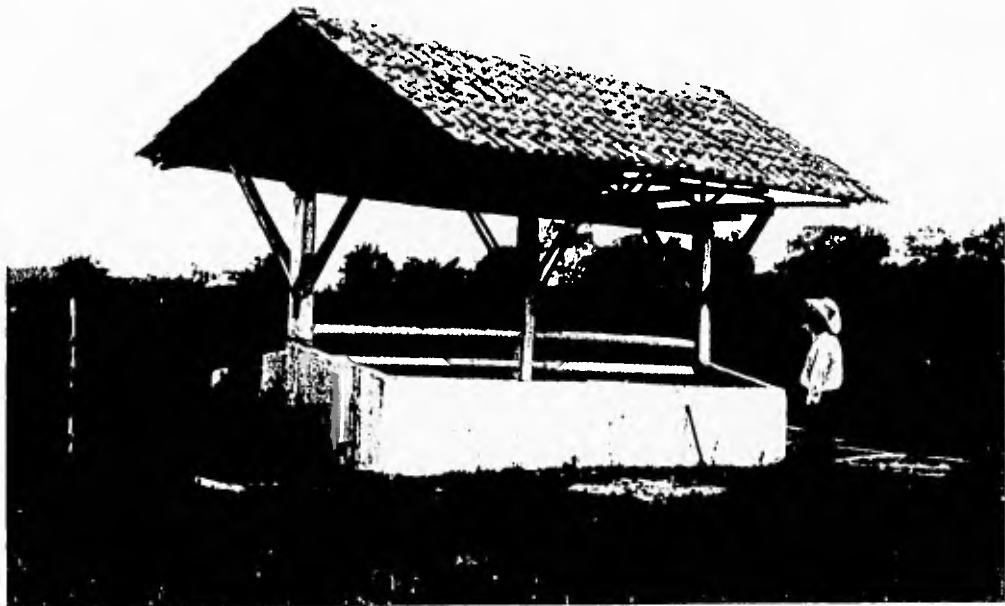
Cubierta formada por cinco armaduras apoyadas al centro, relizada a base de otate utilizando teja plana de gancho y pernos para resolver las uniones.
